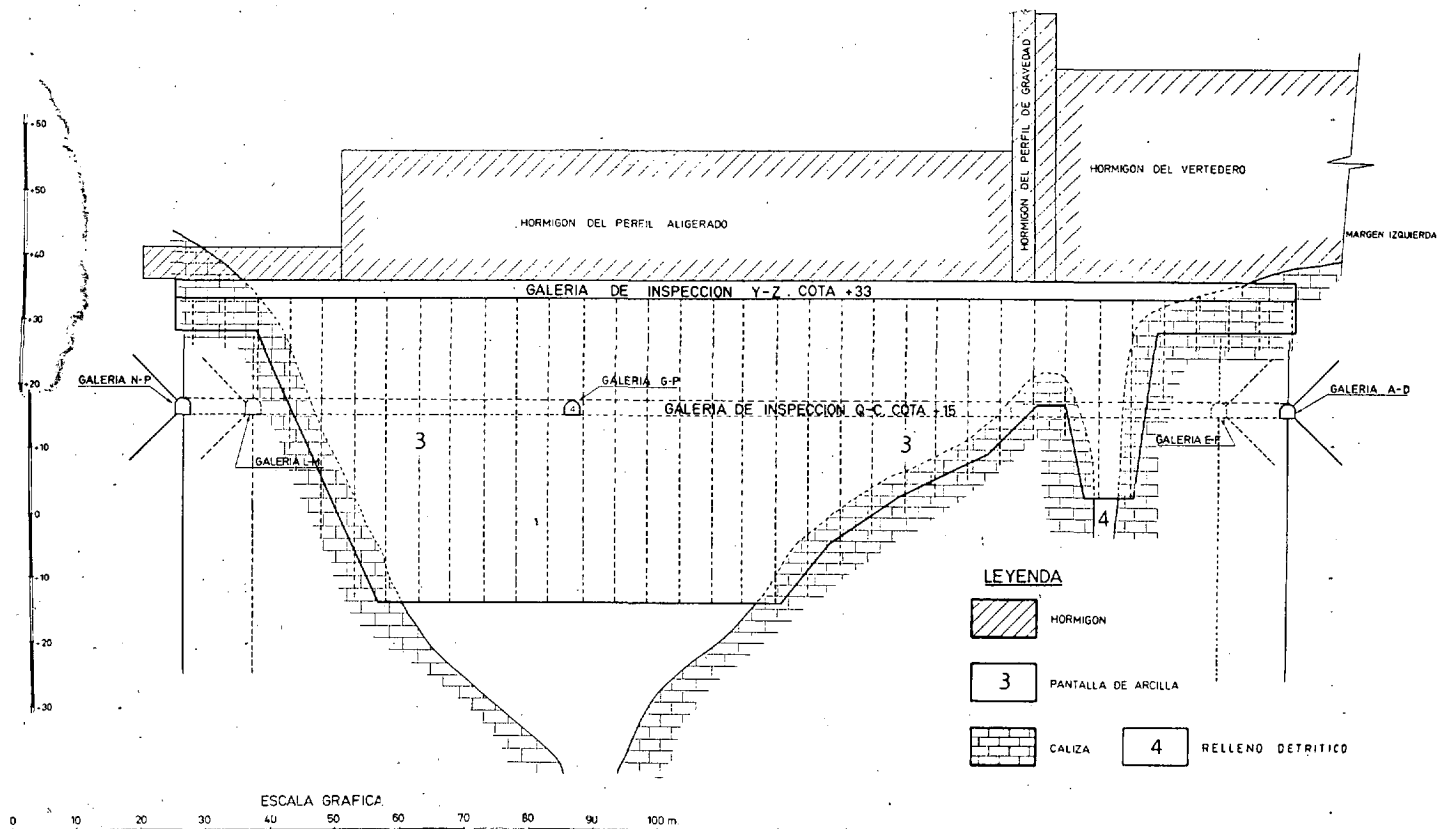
Sistema de impermeabilización del terreno en el pantano de Tous, sección-alzado, por la galería de inspección Y-Z, cota+33.
